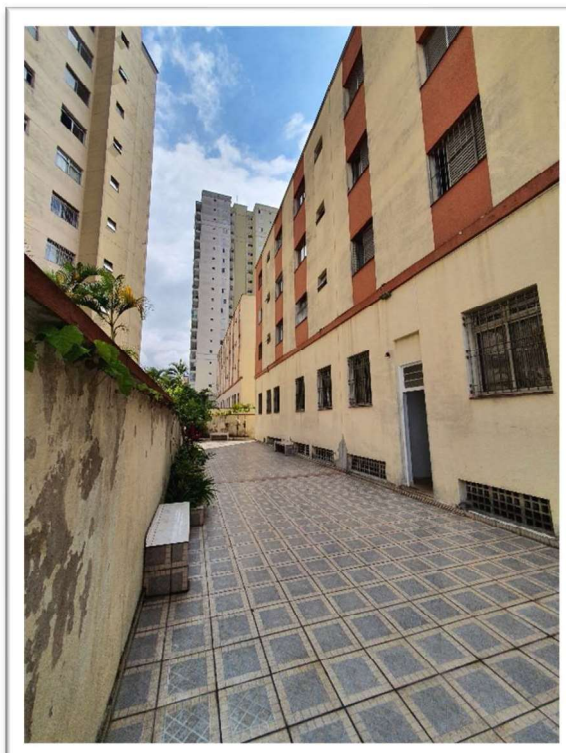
DETALHE DA FACHADA DE FUNDOS DO EDIFÍCIO
